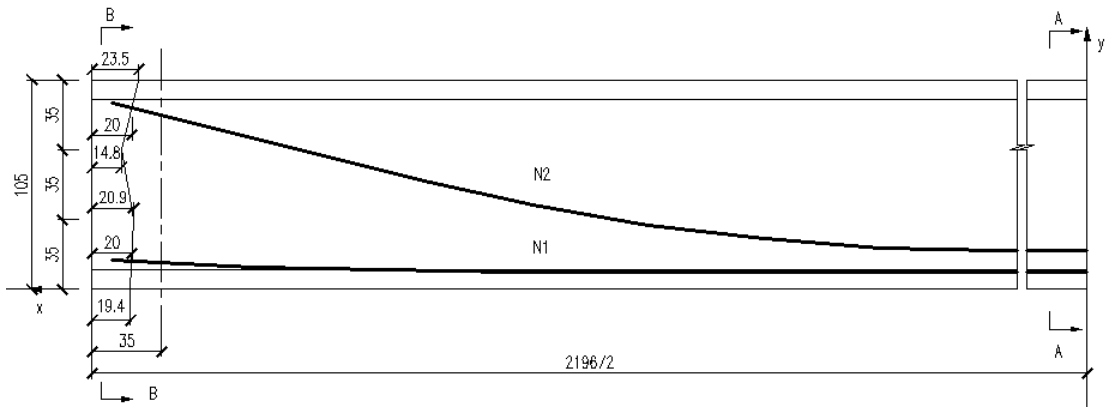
钢束立面布置图（尺寸单位:cm）
